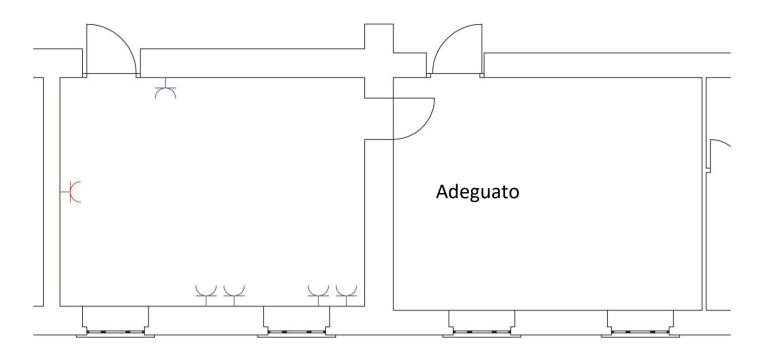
Pianta aula innovativa piano rialzato\_plesso di via Ponte
